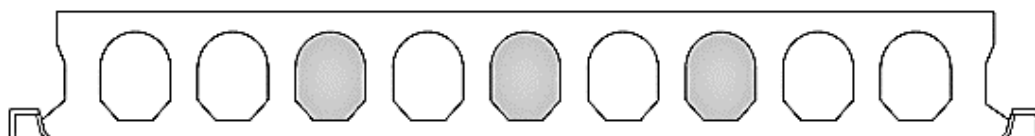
Dimensões das lajes ensaiadas. (ANTUNES, 2012)
